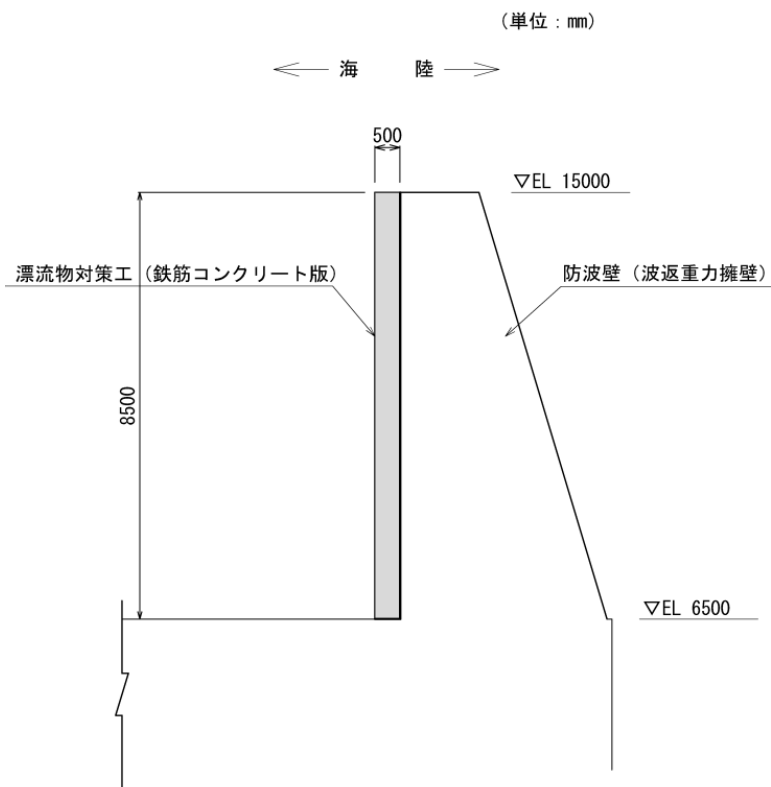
漂流物対策工⑦の構造概要図 (断面図)
